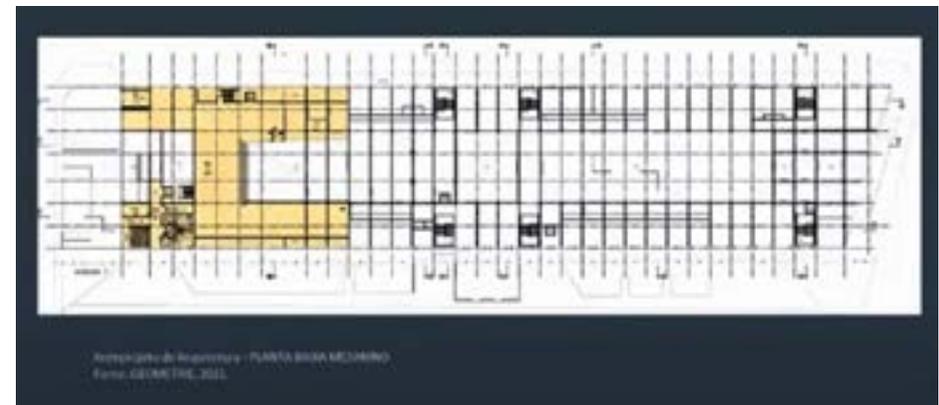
Planta baixa mezanino destinado a reserva técnica do LAAU
